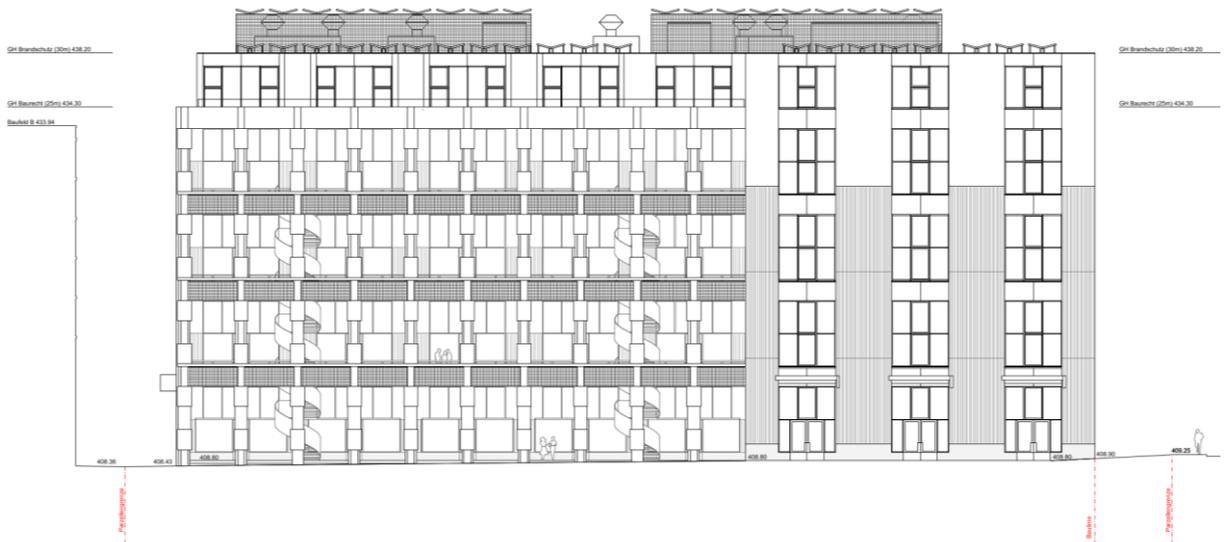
Südwestfassade, ARGE Käferstein Meister & Ekinci Architekten, KOLB Landschaftsarchitektur, April 2020
